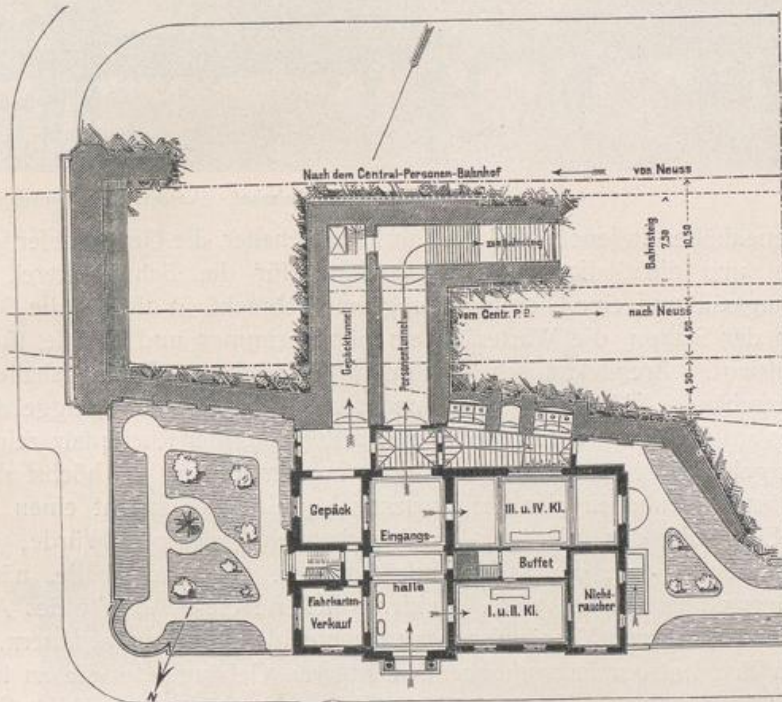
Grundriss des Empfangsgebäudes auf Bahnhof Bilk. 1:600.
